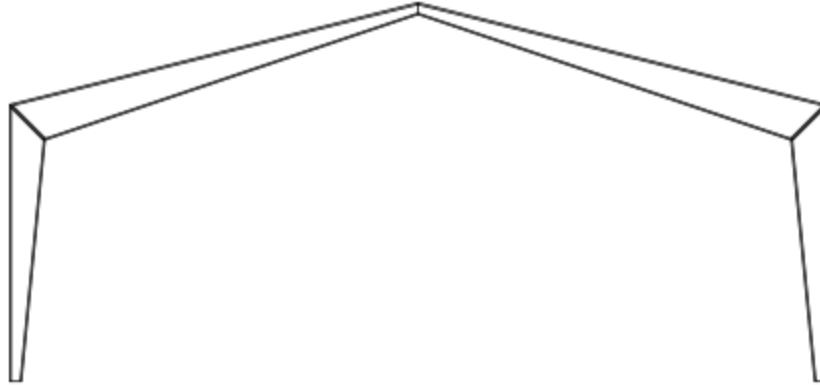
Pórtico Rígido de Alma Llena (Sección variable)
